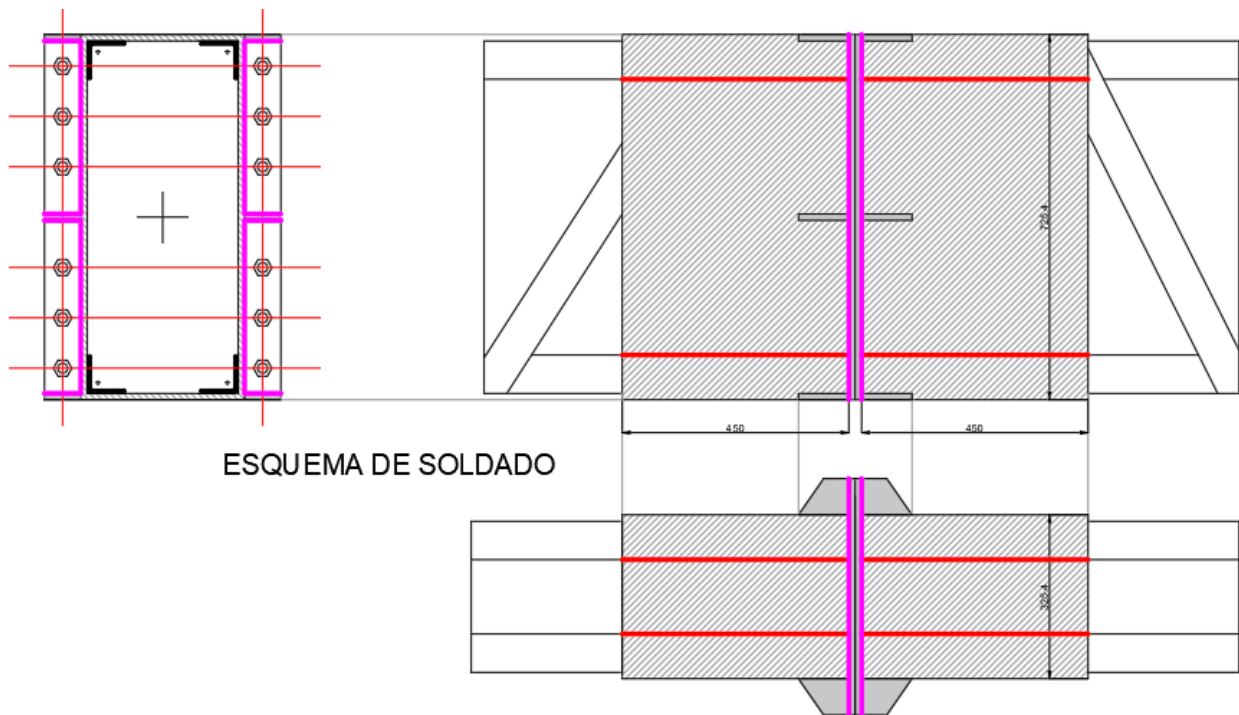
Detalle de unión - soldadura cordones de viga – presilla
